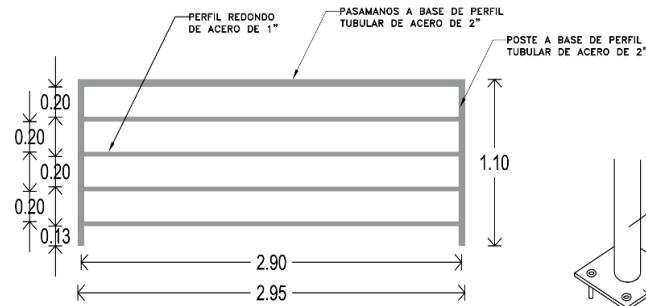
Detalle de herrería de portones. Plano de elaboración propia, 2017. Plano HER, véase pág. 165.
